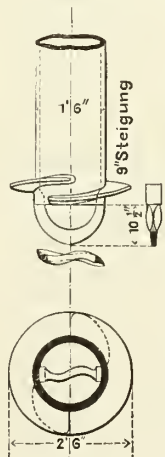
Schraubenform der Pfähle einer Brücke am Mersey.
